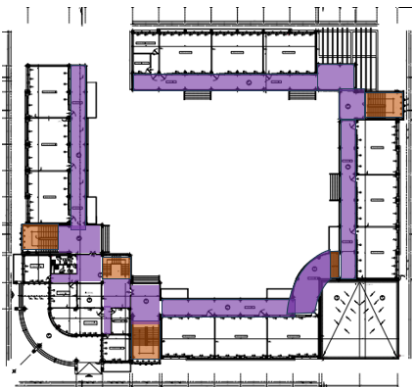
PLAN DU PREMIER ETAGE NIV ; +04.08 ECHELLE :1/50
